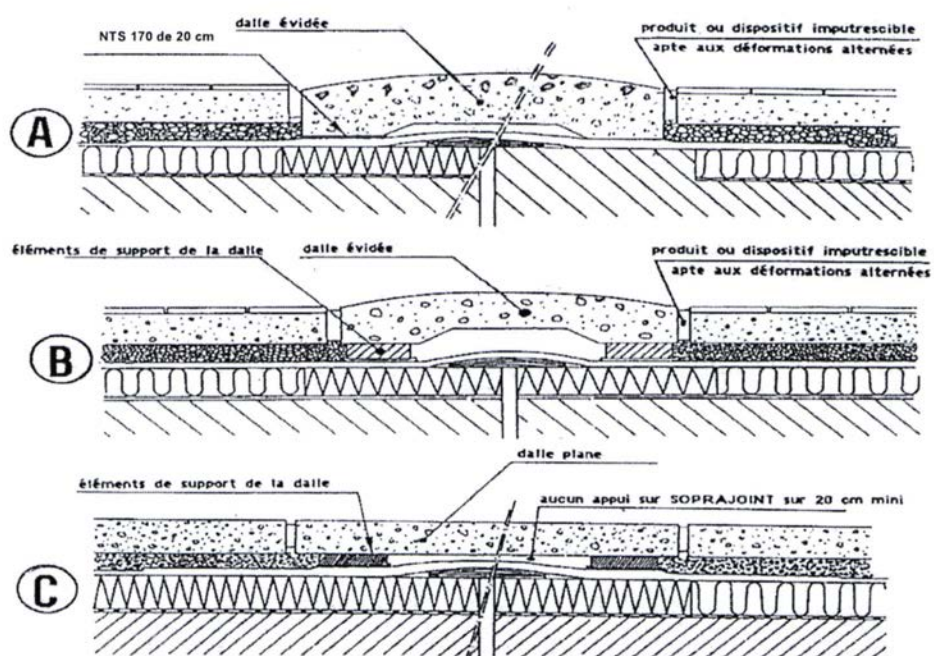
Protection des joints plats en toitures accessibles aux piétons et au séjour
